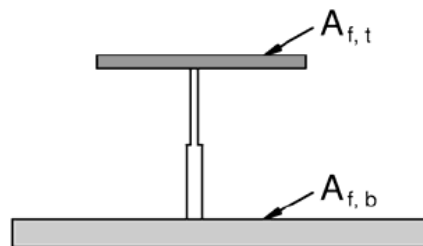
Rapport des sections des Tés de P1 [RFC 06]
